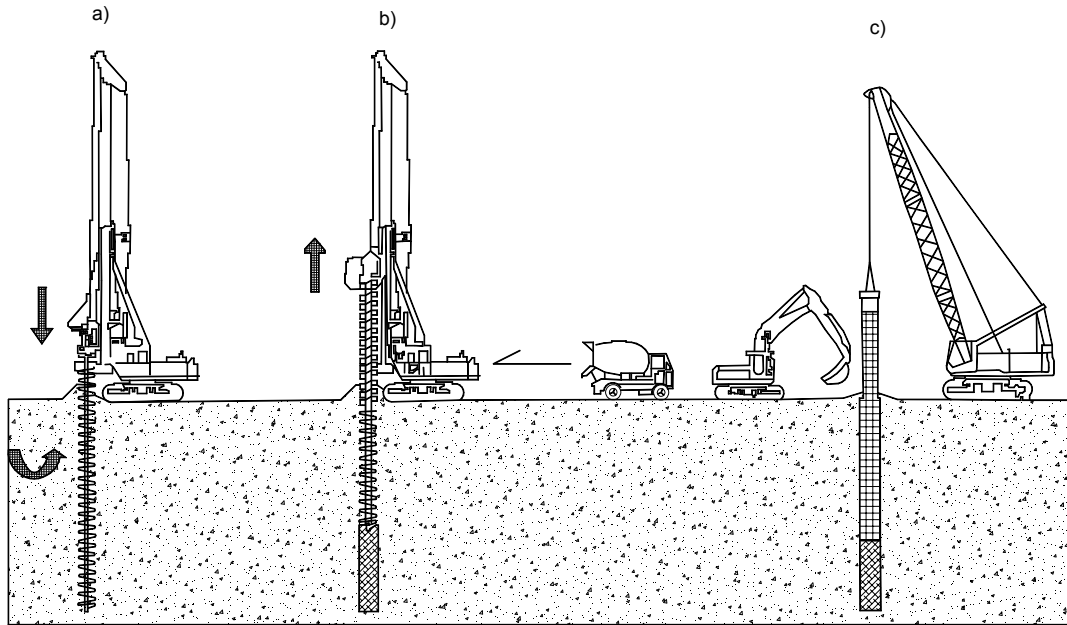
Proceso constructivo de pilotes utilizando equipo helicoidal (auger) continuo.
